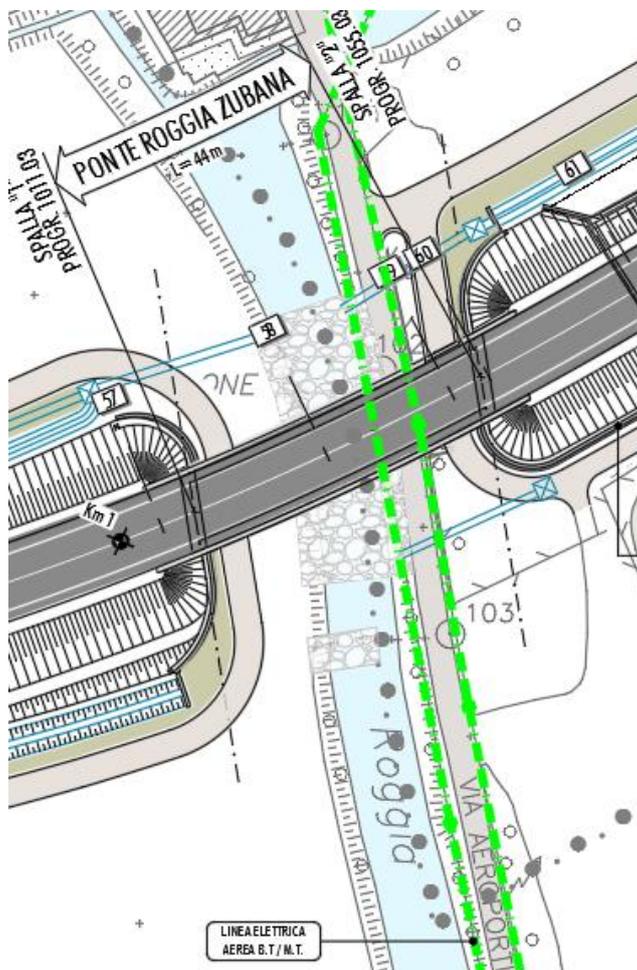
SCHEMA PLANIMETRICO CON INDICAZIONE DELLA POSIZIONE DELLE LINEE MT-BT IN CORRISPONDENZA DEL PONTE SULLA ROGGIA ZUBANA - INTERFERENZA 7
